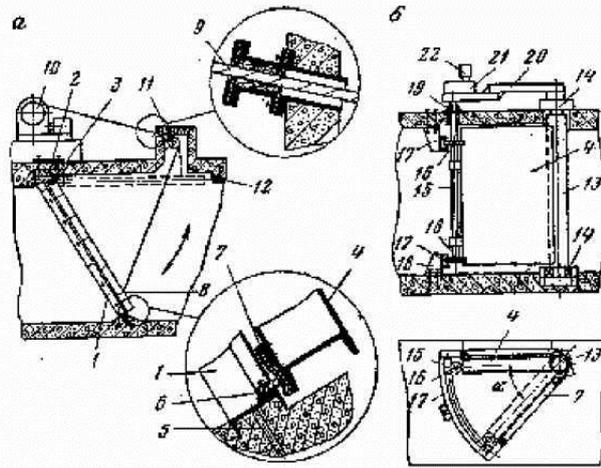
Конструкции ляд: а - лядя падающая, б - лядя самоходная; 1 - рама; 2 - подвесное устройство; 3 - шарнир; 4 - полотно ляды; 5 - крепежный элемент; 6 - полоса резины; 7 - полая резиновая прокладка; 8 - крепежный рым; 9 - канат; 10 - лебедка; 11 - блок; 12 - конечный отключатель; 13 - ось ляды; 14 - подшипник; 15 - приводной вал; 16 - шестерня привода; 17 - сектор; 18 - кронштейн крепления; 19 - изолирующая прокладка; 20 - рама привода; 21 - редуктор; 22 - двигатель
